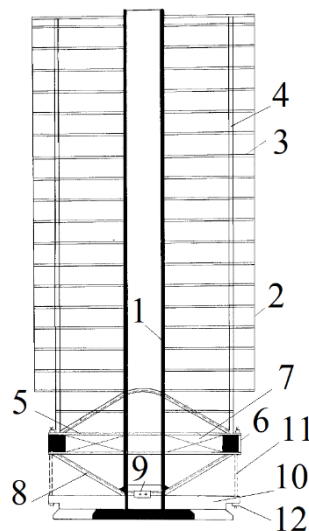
Многоэтажное сейсмостойкое здание типа башни: 1 – опорный ствол; 2 – конструкция этажей; 3 – плиты перекрытия; 4 – колонны; 5 – связево-ростверковая опора; 6 – контурный ростверк; 7 – связевые диафрагмы; 8 – подвески; 9, 12 – элементы натяжения; 10 – фундамент; 11 – выключающиеся связи
